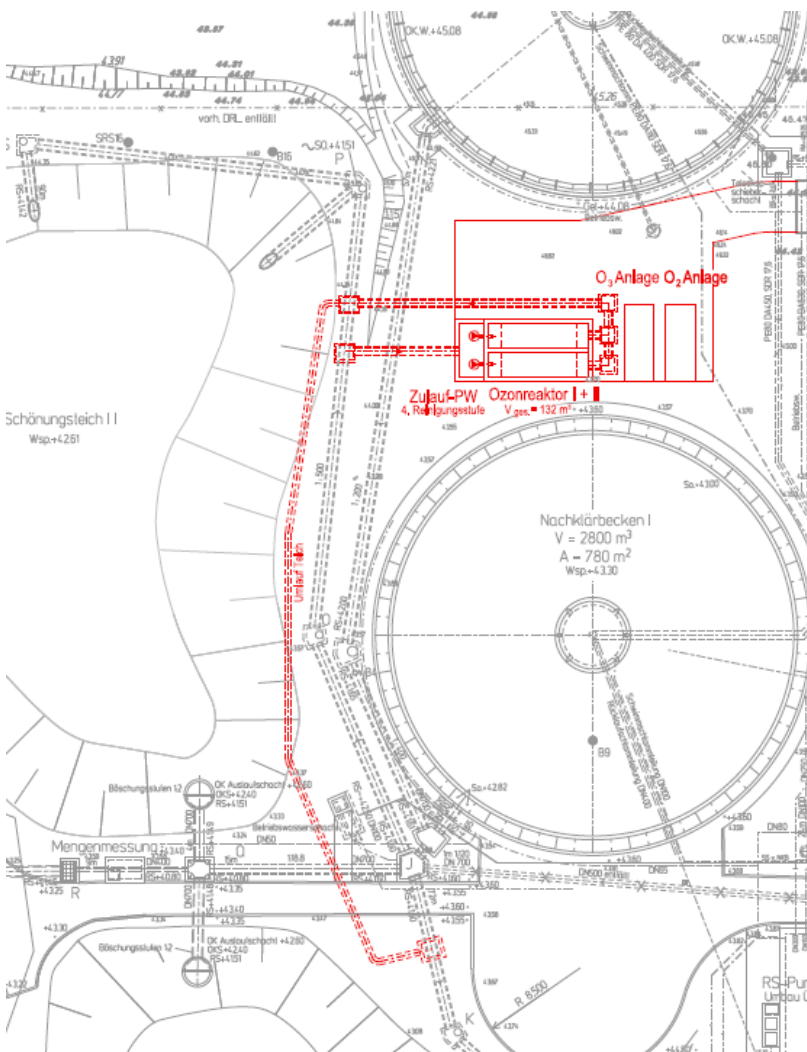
Lageplanausschnitt Variante 2: Ozonung mit nachgeschaltetem Schönungsteich
